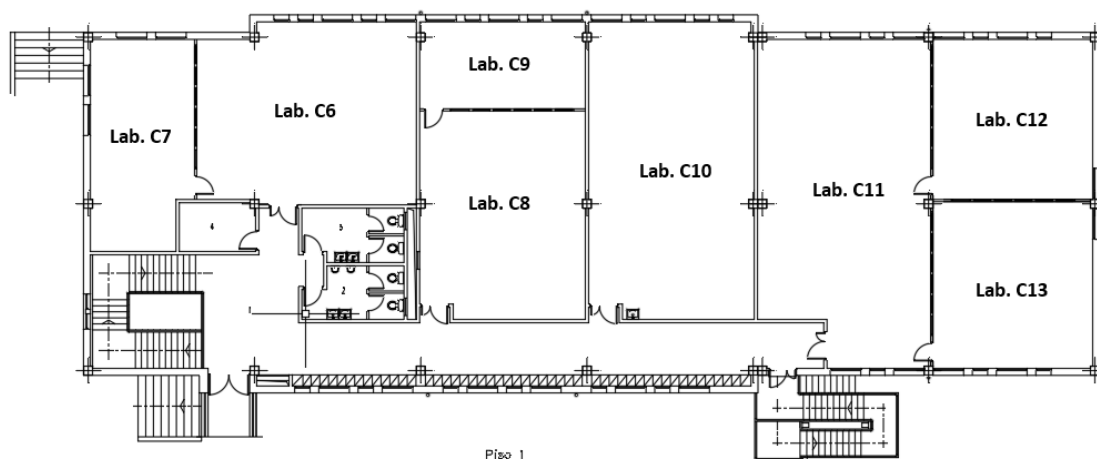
Planta do piso 1 do Bloco C da ESTCB.
